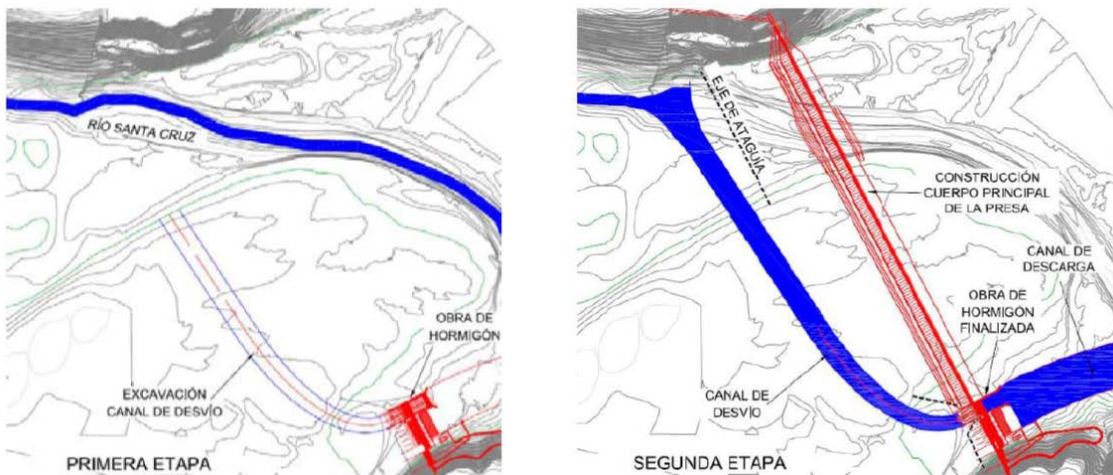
JC - Obra de desvío (Fuente: Proyecto Ejecutivo)
